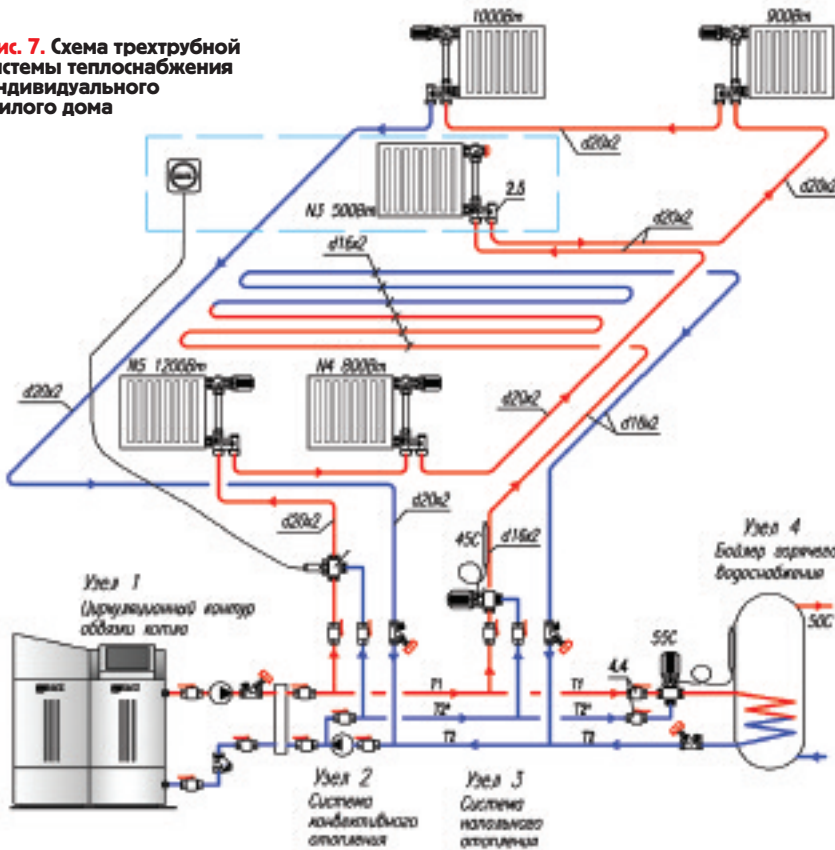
Схема трехтрубной системы теплоснабжения индивидуального жилого дома
